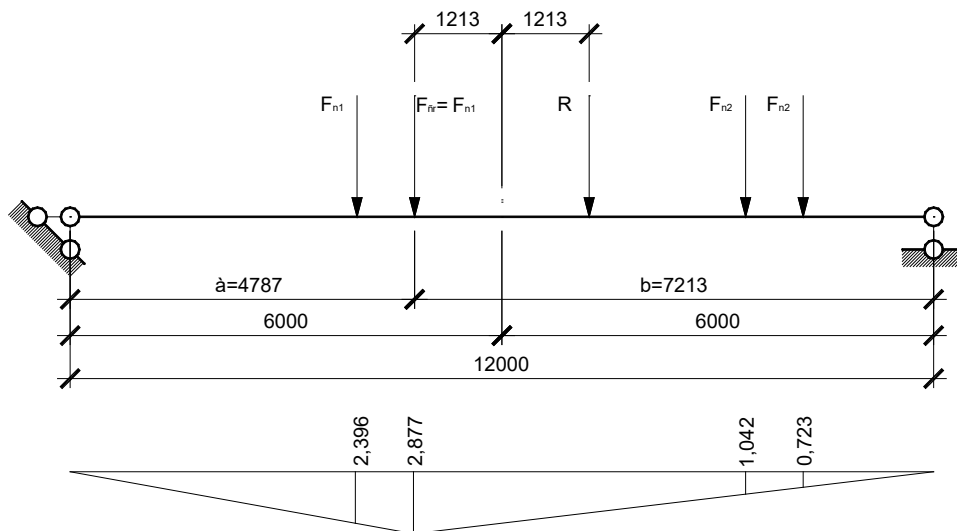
Розрахункова схема навантаження підкранової балки нормативним вертикальним навантаженням
